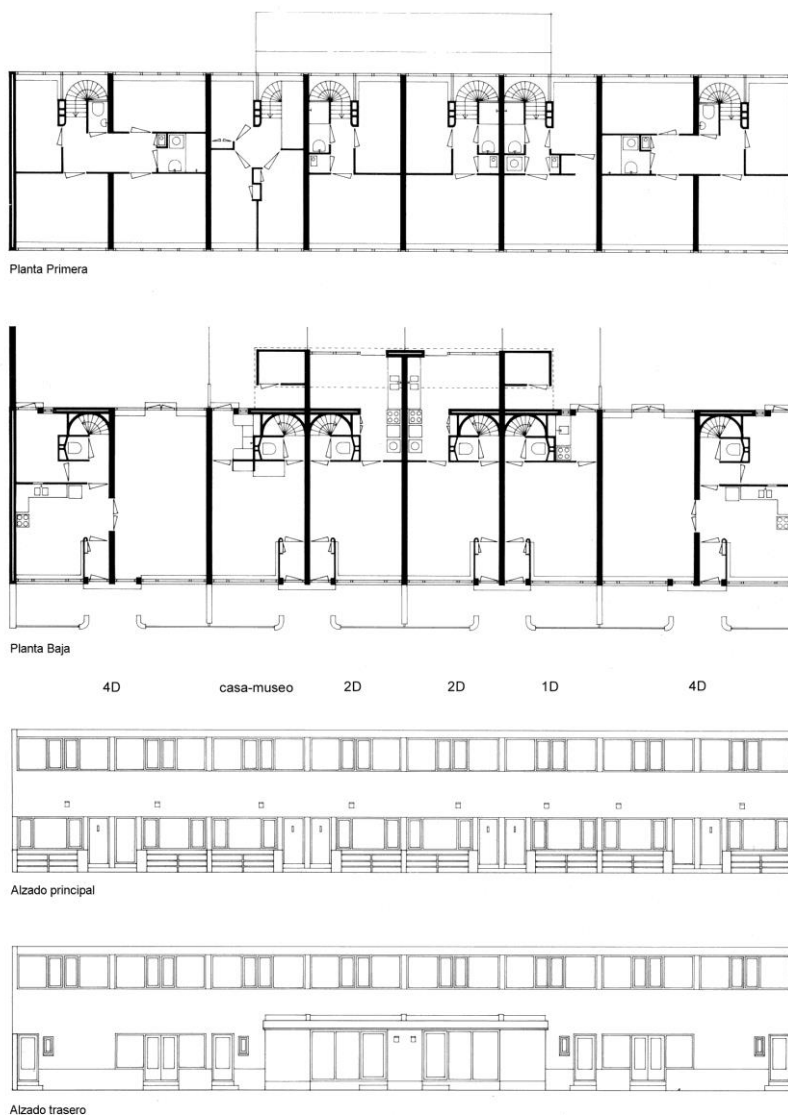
Plantas y alzados del proyecto de reconstrucción sobre el bloque en la calle Hendrik Idoplein en Kiefhoek (Wytze Patijn, 1989). Montaje de la autora. Fuente: CUSVELLER, Sjoerd (red.) – De Kiefhoek: een woonwijk in Rotterdam. Rotterdam: Stichting Museumwoning De Kiefhoek, 1990, p. 103.
